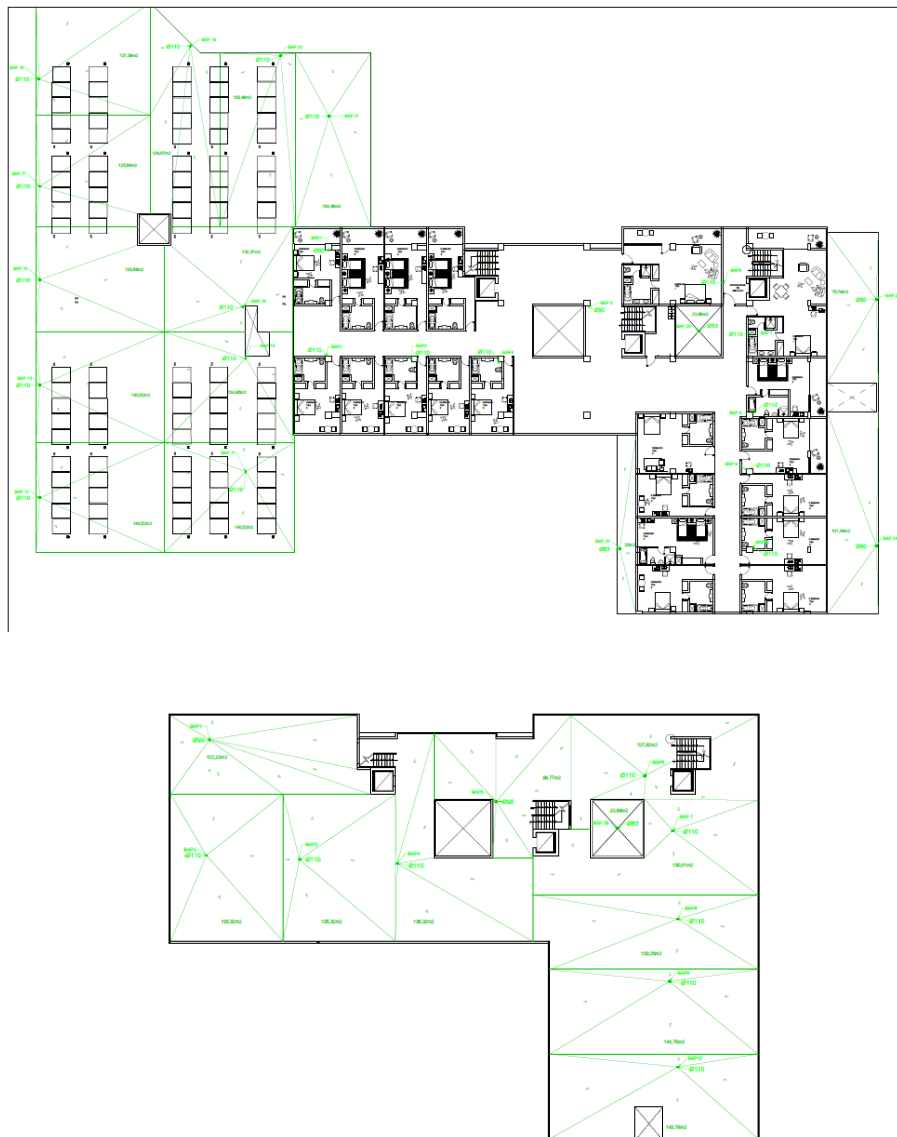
Planificación de sumideros en cubiertas. Planos del proyecto
